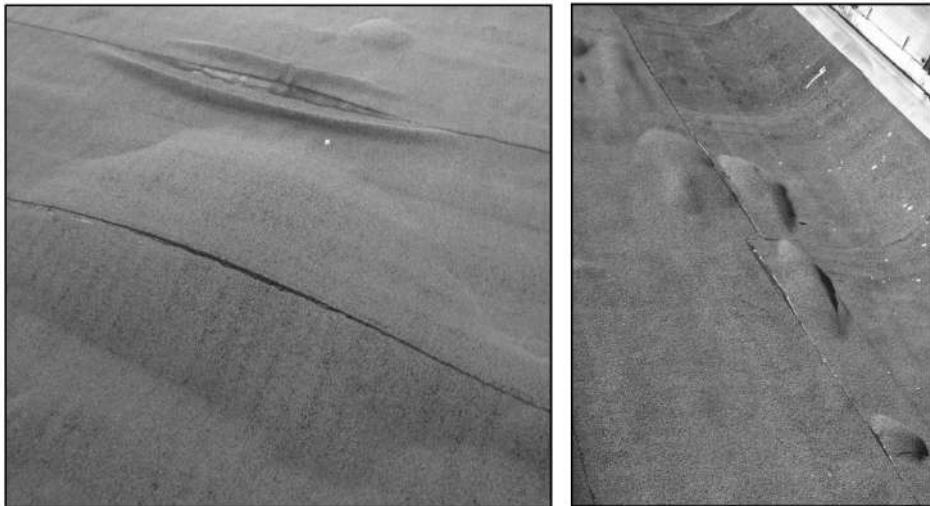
«Дутики» и непроклеи рулонного гидроизоляционного ковра
